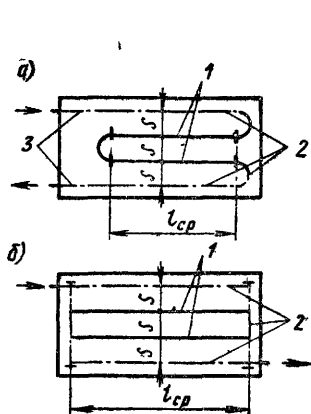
Схемы нагревательных элементов бетонной отопительной панели
